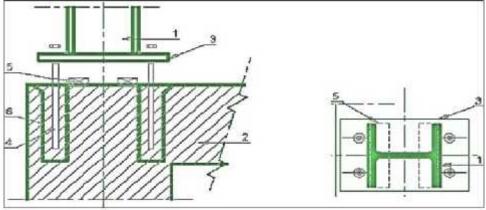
encastrement du poteau dans une dalle en béton Source : www.rhoul.fr/Rhoul_Archi/Fichiers_htm/reponsehtm
